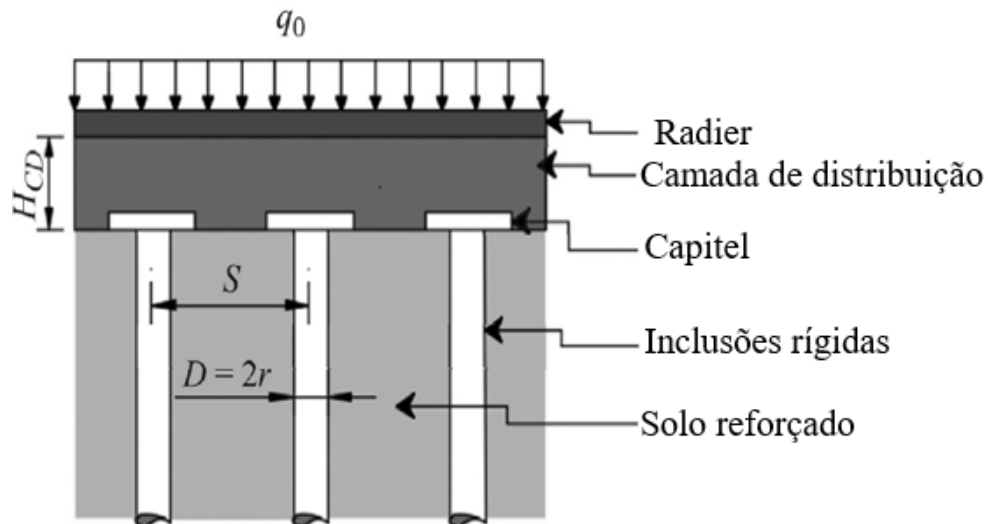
Esquema geral de uma fundação reforçada com inclusões rígidas (Modificado Rebolledo et al., 2019)
